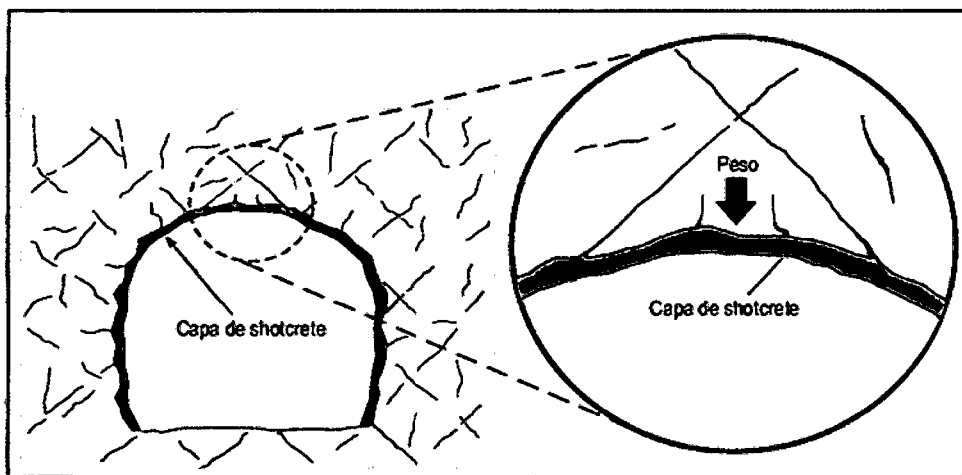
Lanzado Shotcrete en un frente (in. Consorcio Minero Horizonte)
